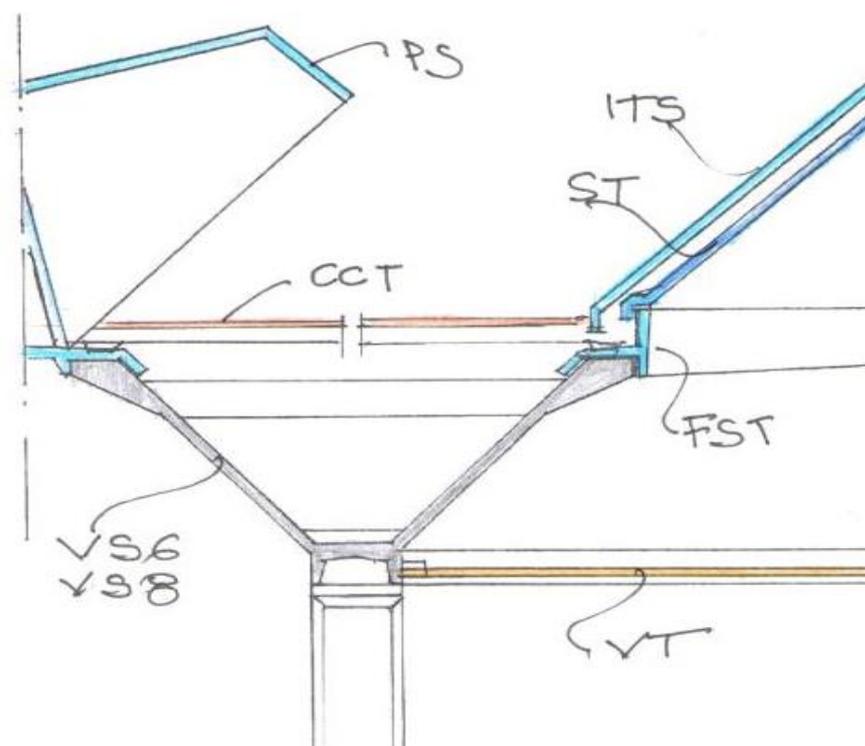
Corte Longitudinal do Módulo Tipo, detalhe central. Desenho do autor.
